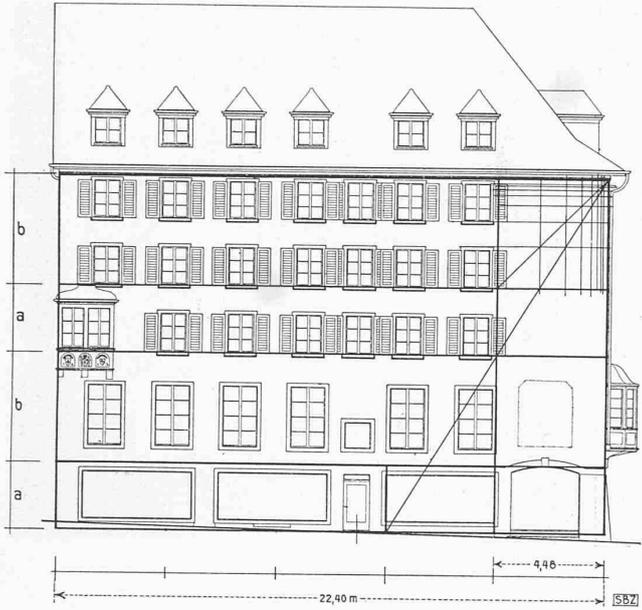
Fassaden-Schema und «Goldener Schnitt». — 1 : 300
